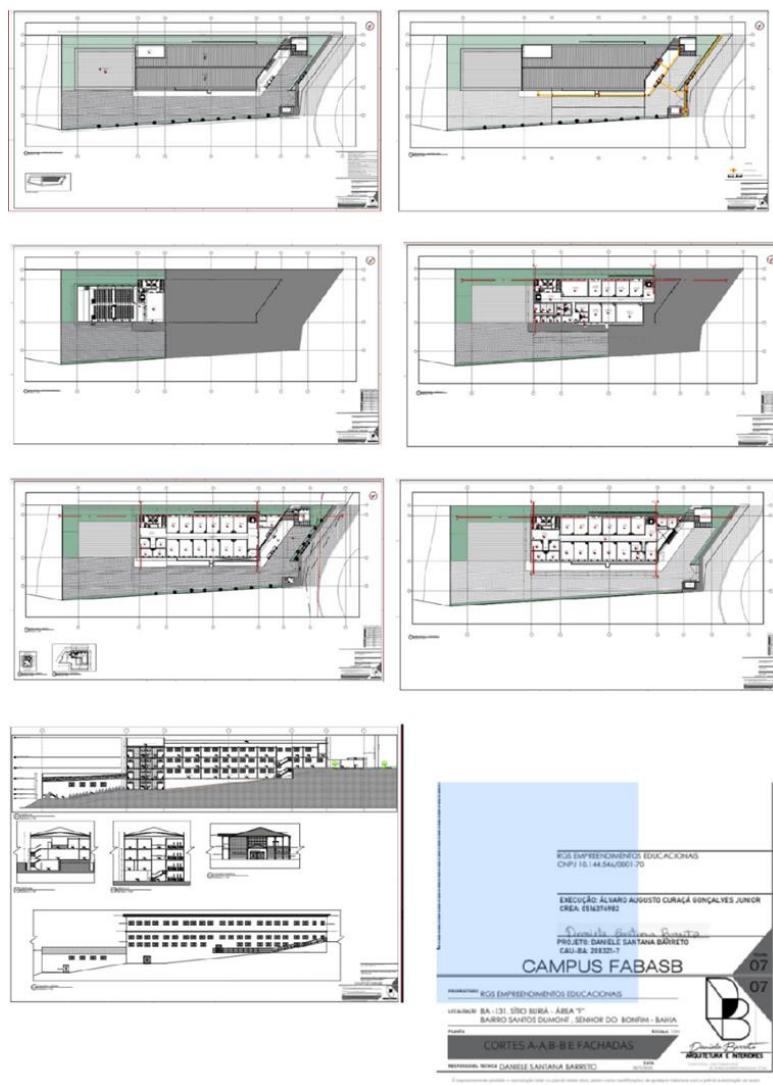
PLANTA DA NOVA SEDE DA FABASB
